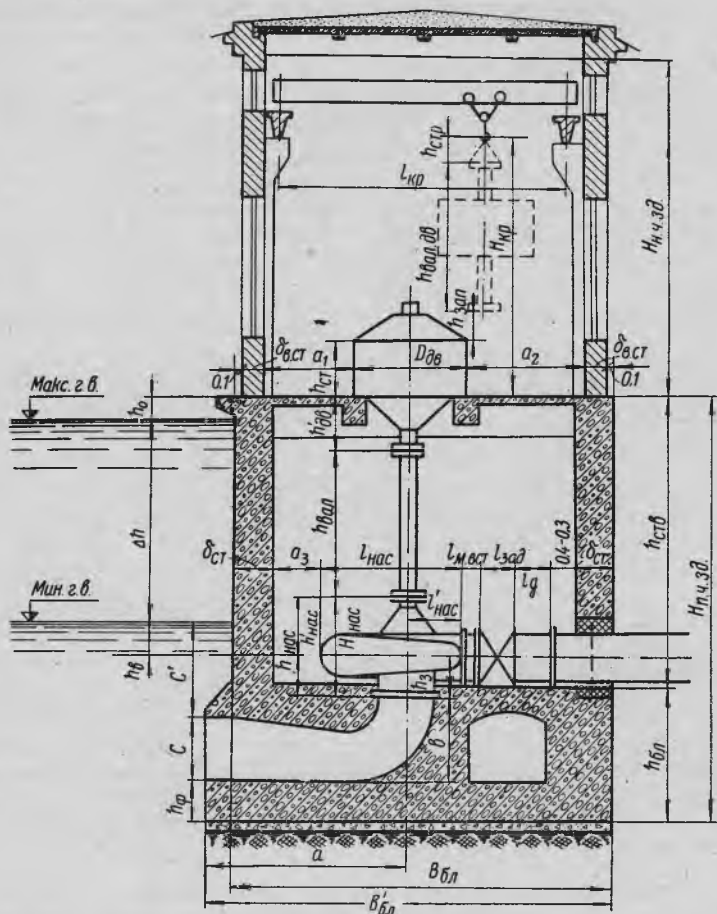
Схема к определению основных размеров здания насосной станции (поперечный разрез).
